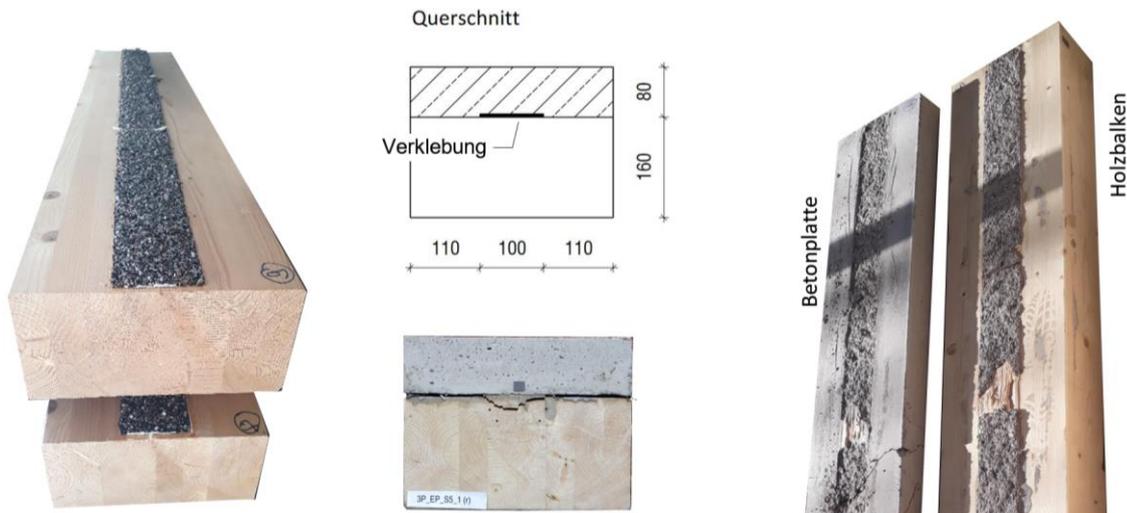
Kurze Biegeträger mit schmaler Fuge: Links: Vor dem Betonieren. Rechts: Nach den Versuchen mit Beton- und Holzversagen. Das Bild zeigt vorwiegend Betonversagen
